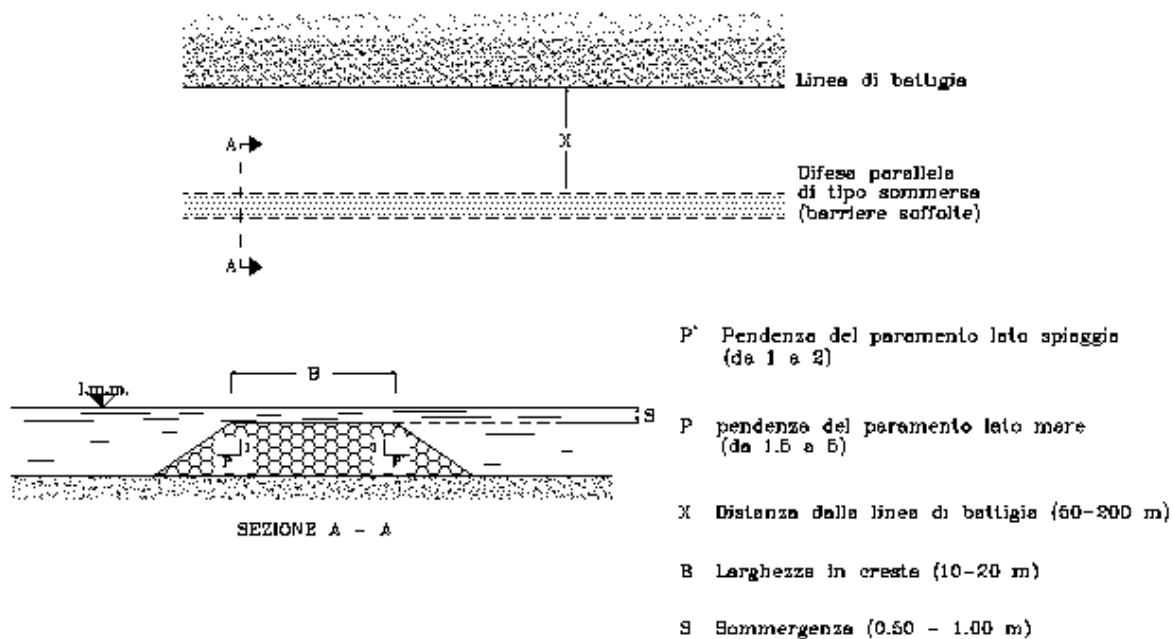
Sezione e pianta di una difesa con barriera distaccata del tipo sommerso.
